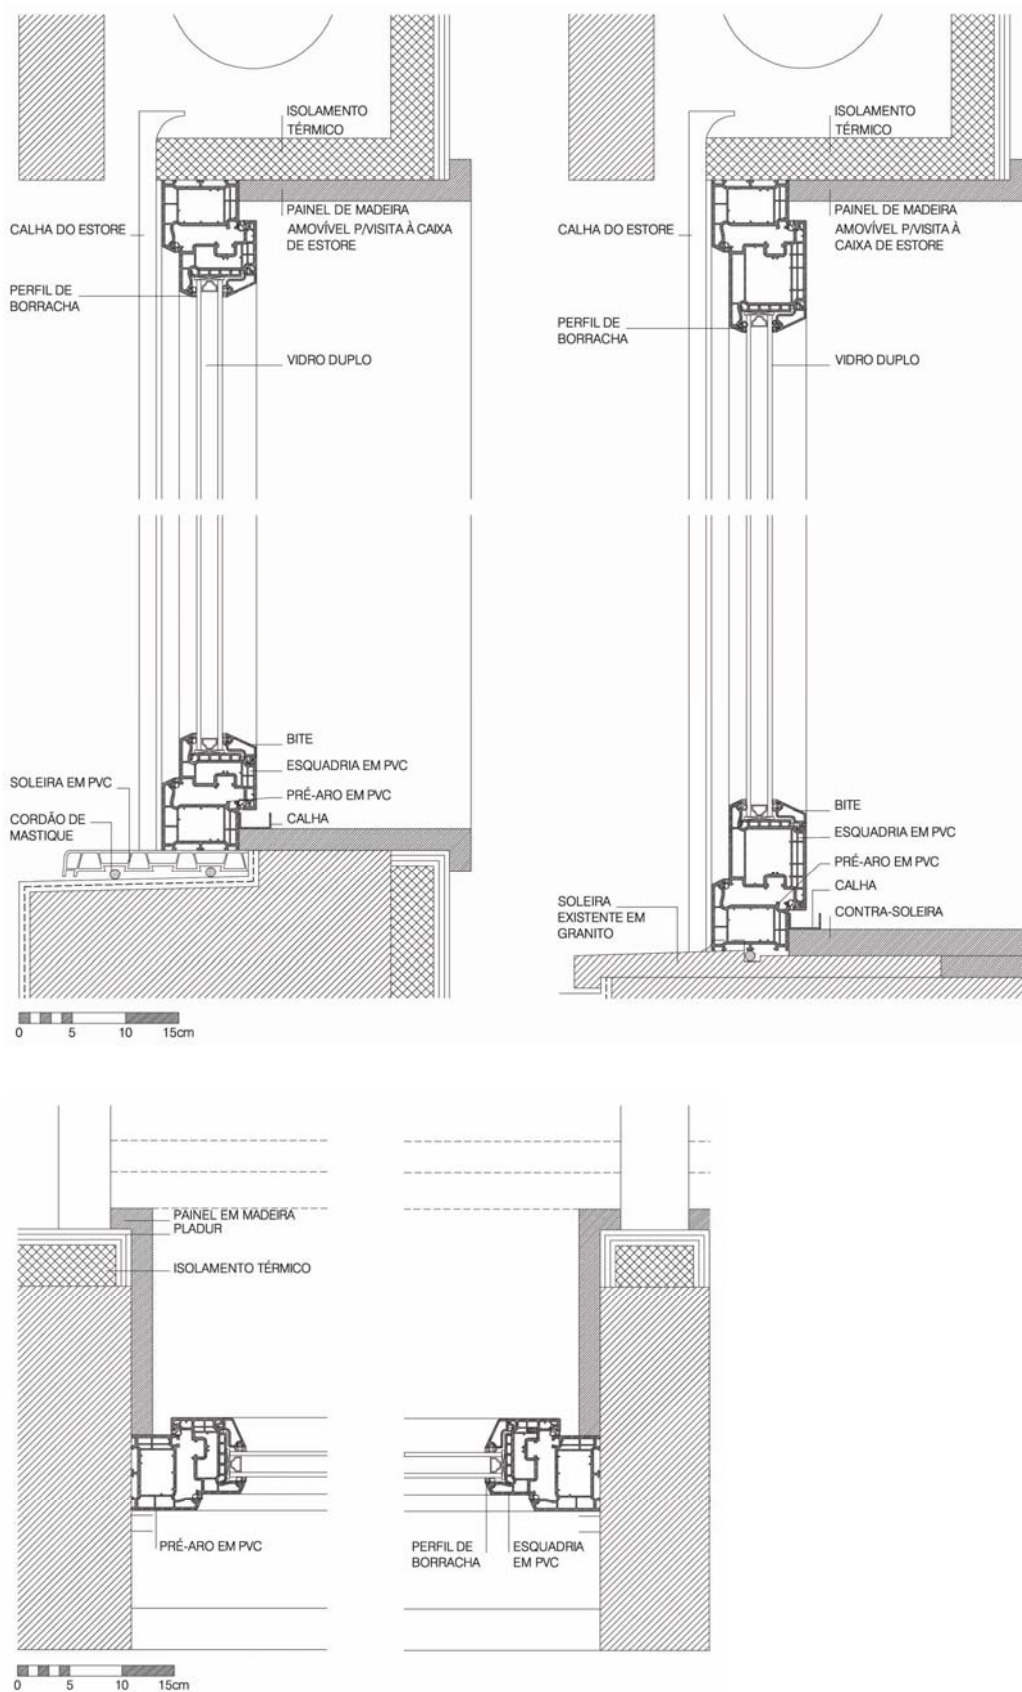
Substituição da caixilharia existente através da selecção exigencial de uma nova caixilharia - caso de estudo em PVC. Pormenor do corte vertical da janela, pormenor do corte vertical da porta e pormenor do corte horizontal da janela.
